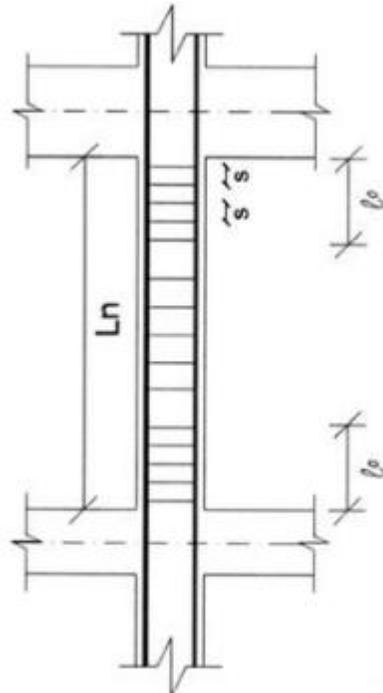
Esquema espaciamento de estribos para columnas de concreto
